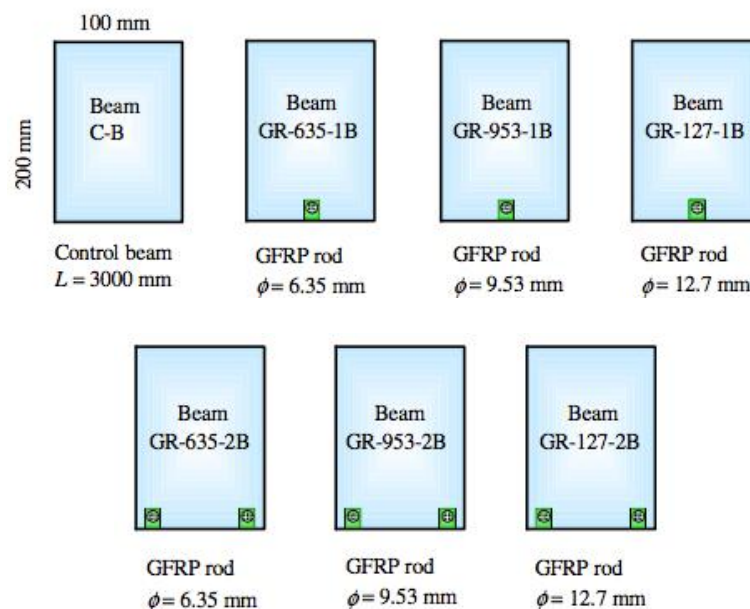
Seção transversal das vigas reforçadas com barras de GFRP (Yusof e Saleh, 2004).
